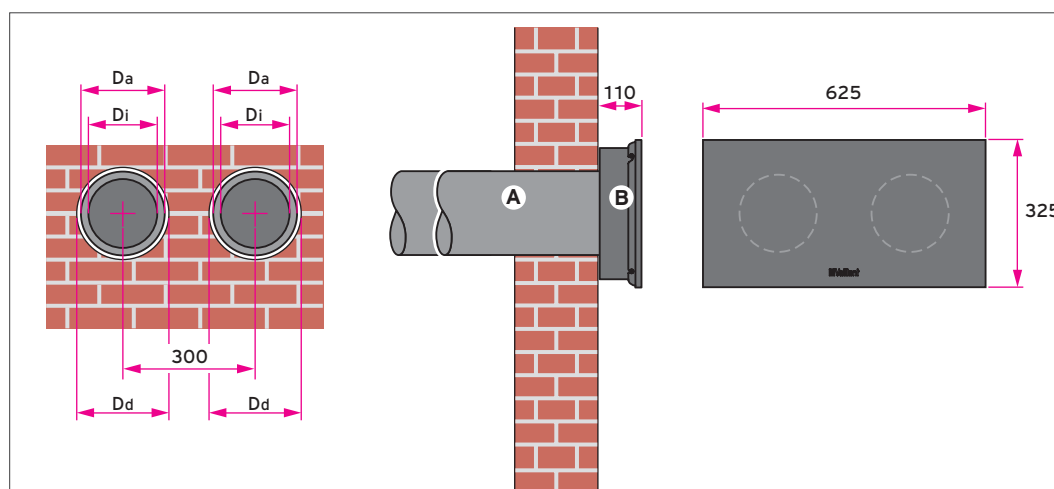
Doppel-Fassadendurchführung (recoVAIR 260/360)
